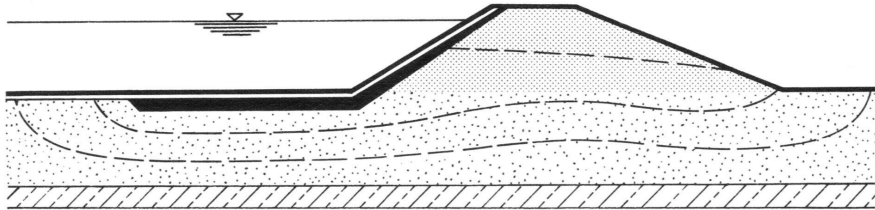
Deich mit Oberflächenabdichtung mit Dichtungsteppich [DVWK, 1986]
